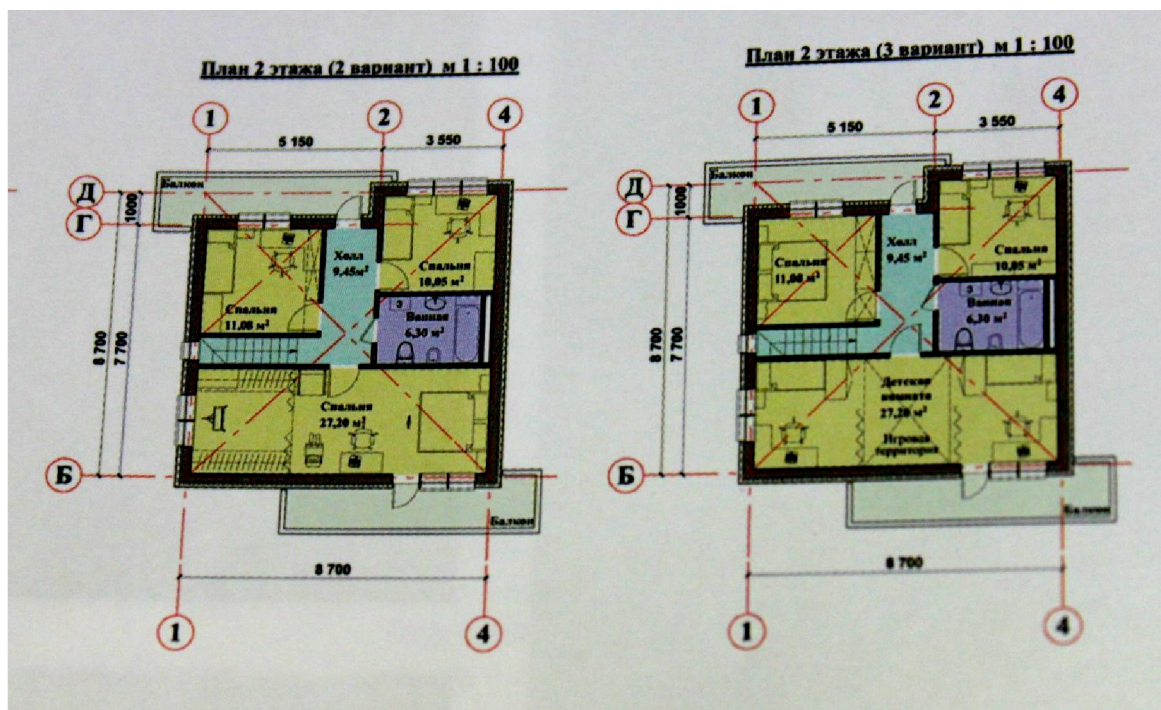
План 2 этажа (2ой и 3ий вариант) индивидуального дома
